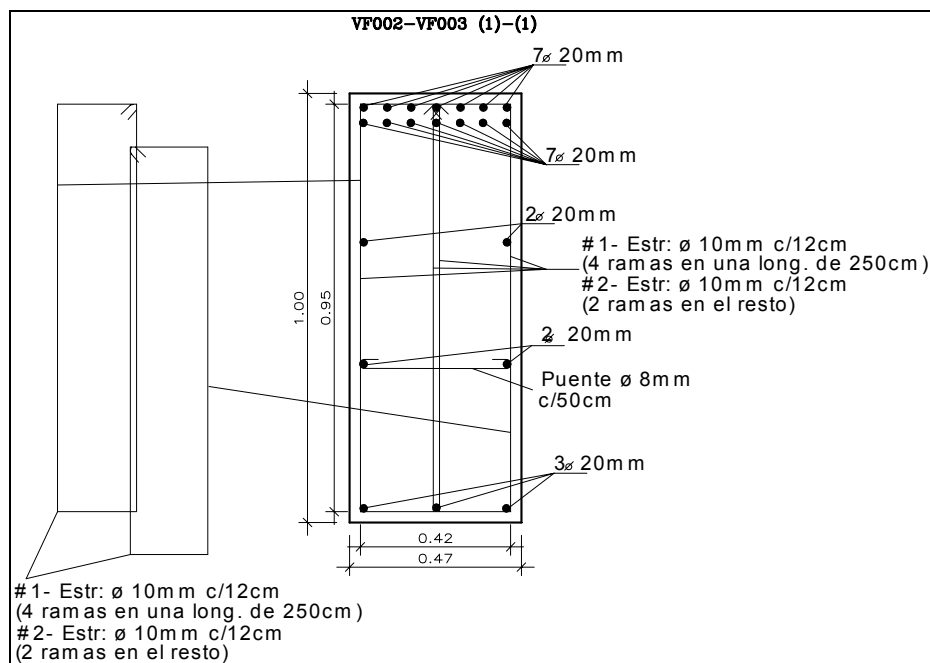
Detalle de disposición de armaduras en vigas de fundación ubicada por debajo del sistema de aislamiento, tramo central (Ver también Capítulo 9).
